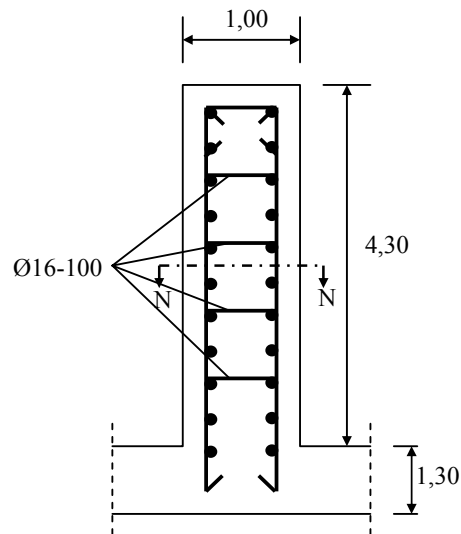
Penulangan Slab Beton Pondasi Bangunan Penerus
